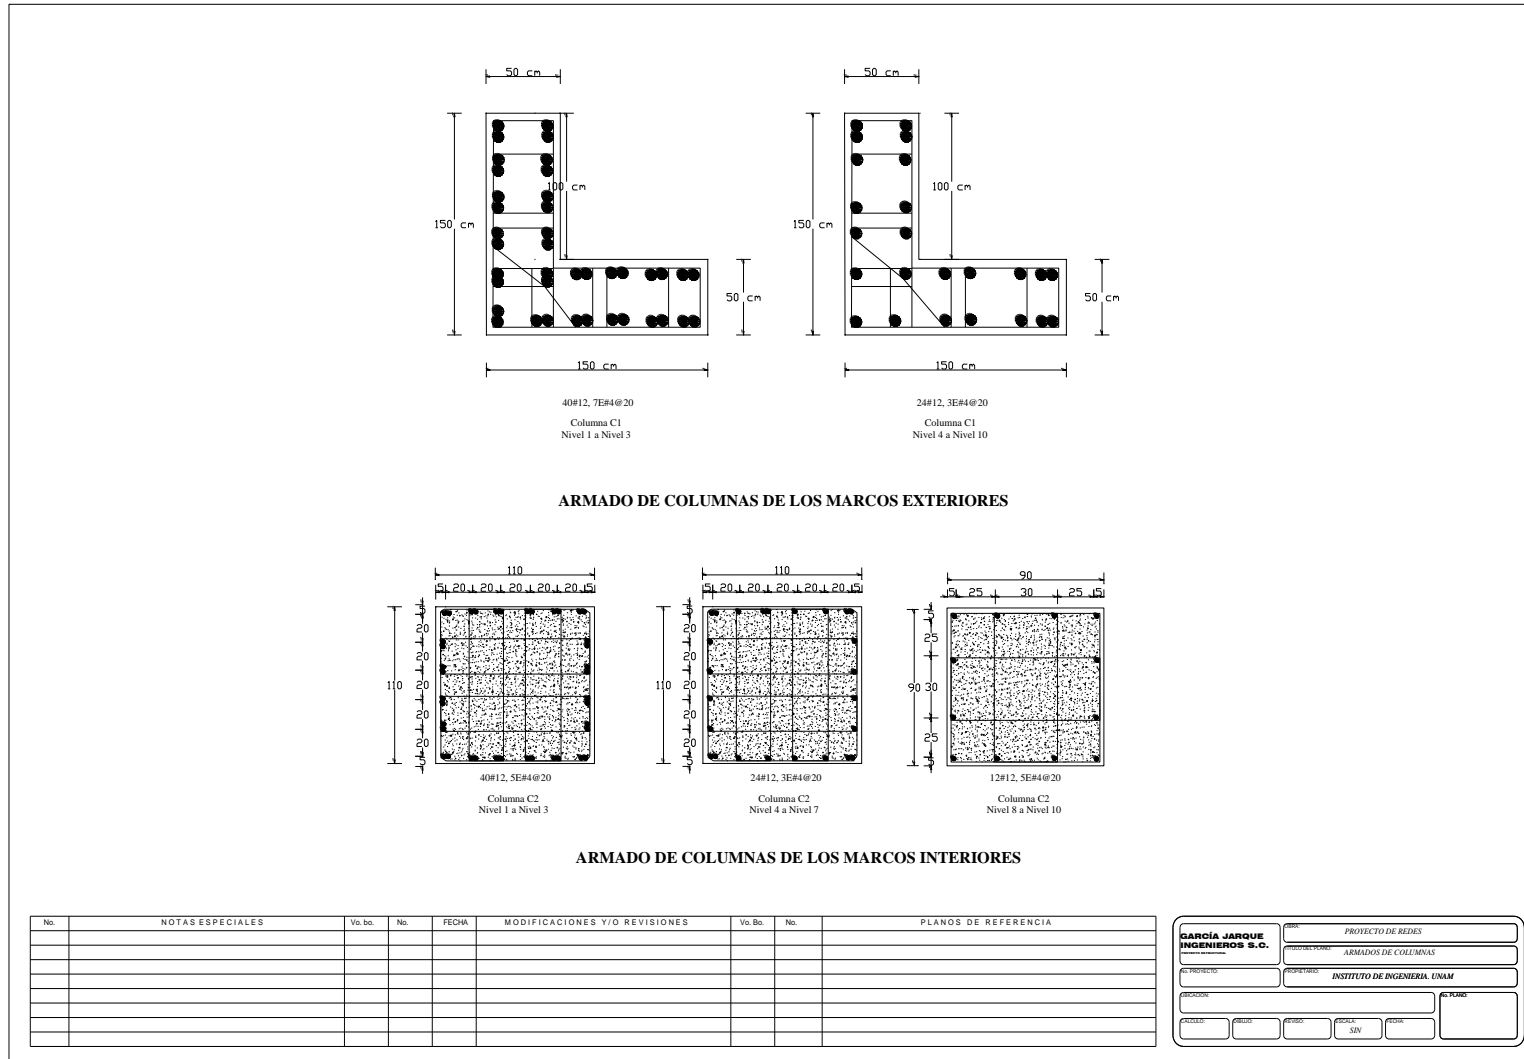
Detalles estructurales del edificio de 10 niveles diseñado con el RCDF-04
